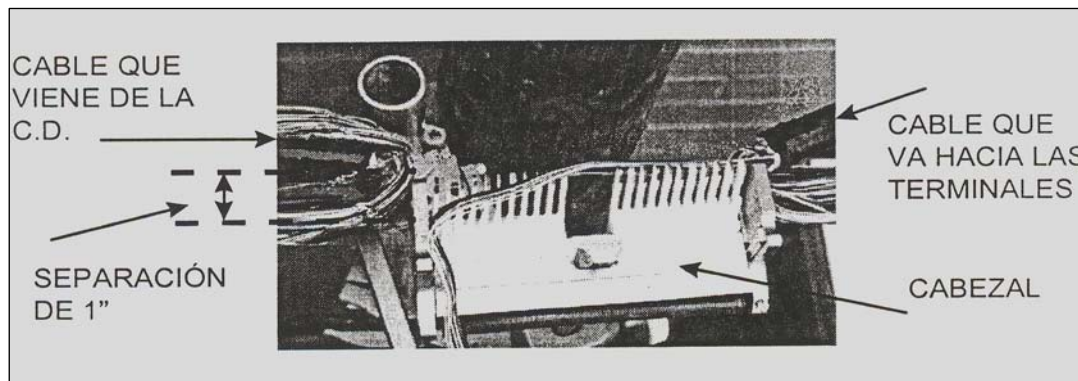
Separación del Cabezal y los Cables Para Empalme en Poste con el Cierre en Posición Horizontal.
